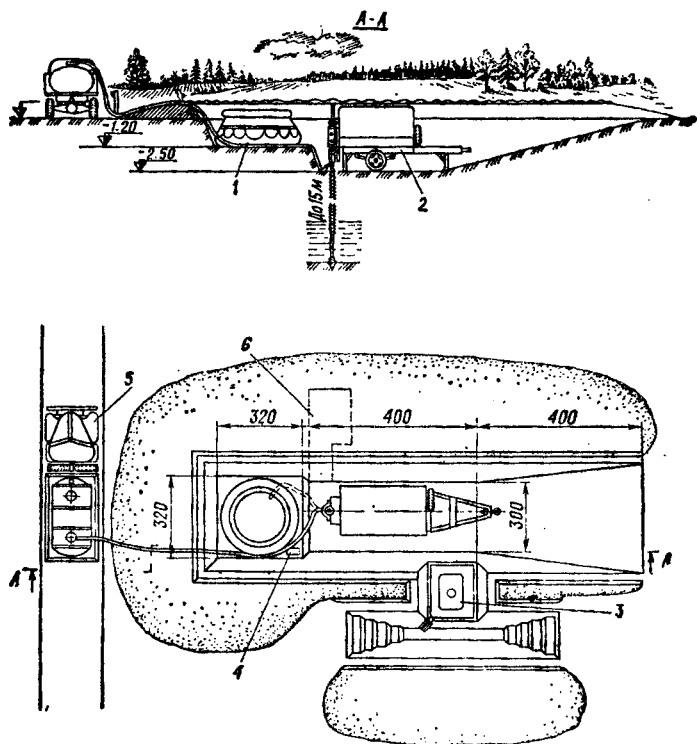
Пункт водоснабжения на установке для добычи грунтовых вод УДВ-15 (вариант):
